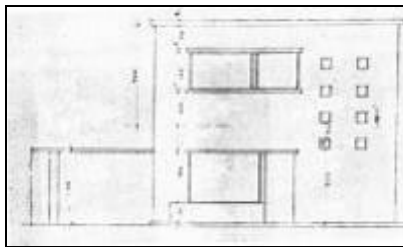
e. Vivienda LV-2. Fachada (1952)
